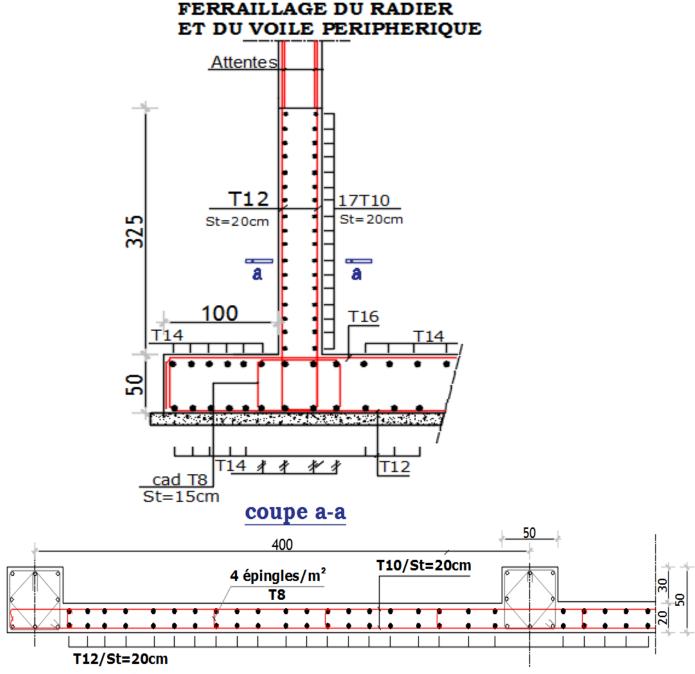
Schéma de ferraillage du voile périphérique.
